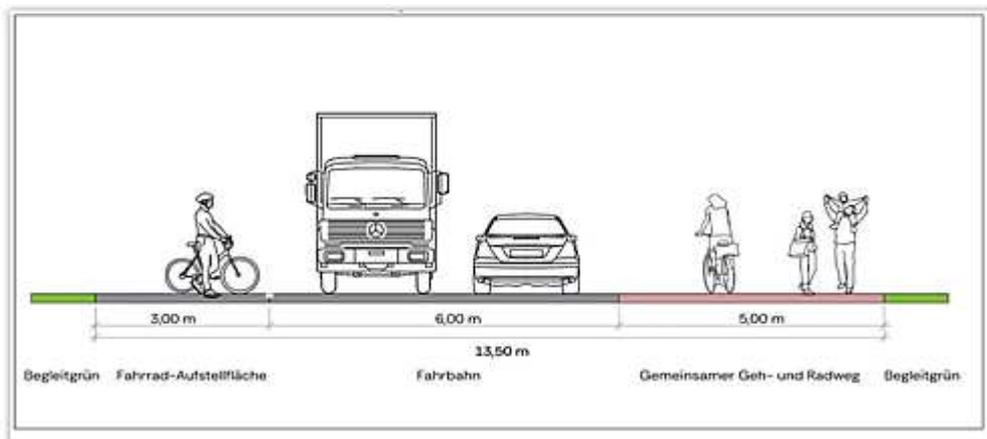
Querschnittsentwurf künftige Querungsstelle Hauptstraße Höhe Bahnhofstraße
